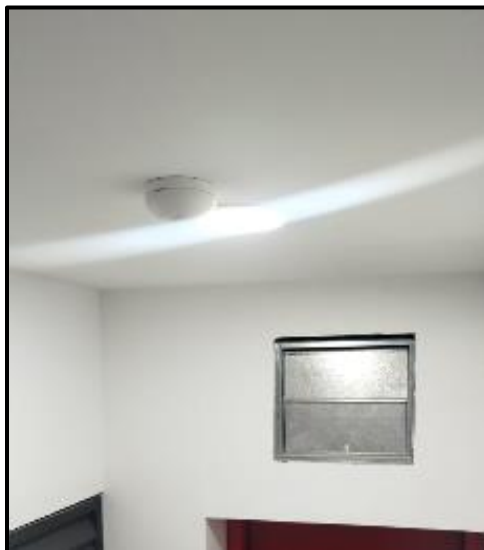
Luminaria instalada en las escaleras de emergencia piso 1
